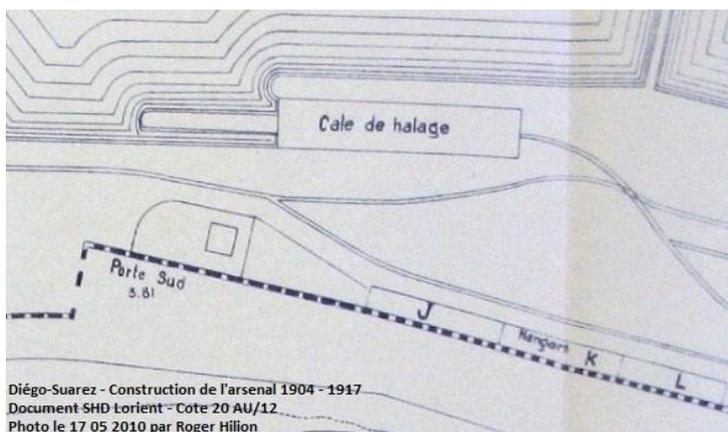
Situation de la cale de halage (Extrait de plan) (Archives SHD Lorient)
